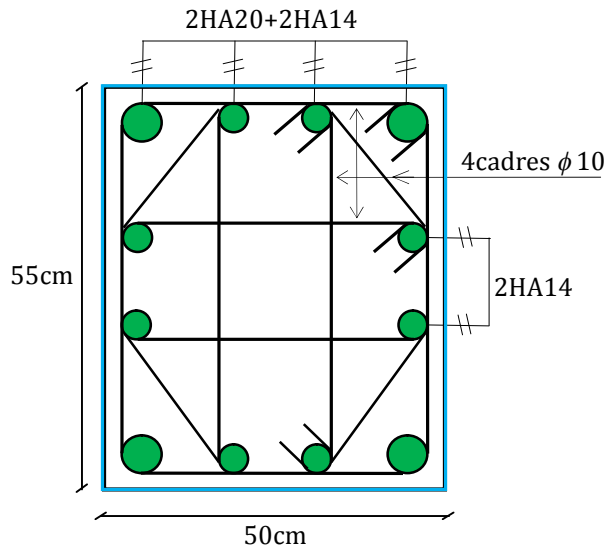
Schéma de ferrailage des poteaux RDC et 1^{er} étage.
